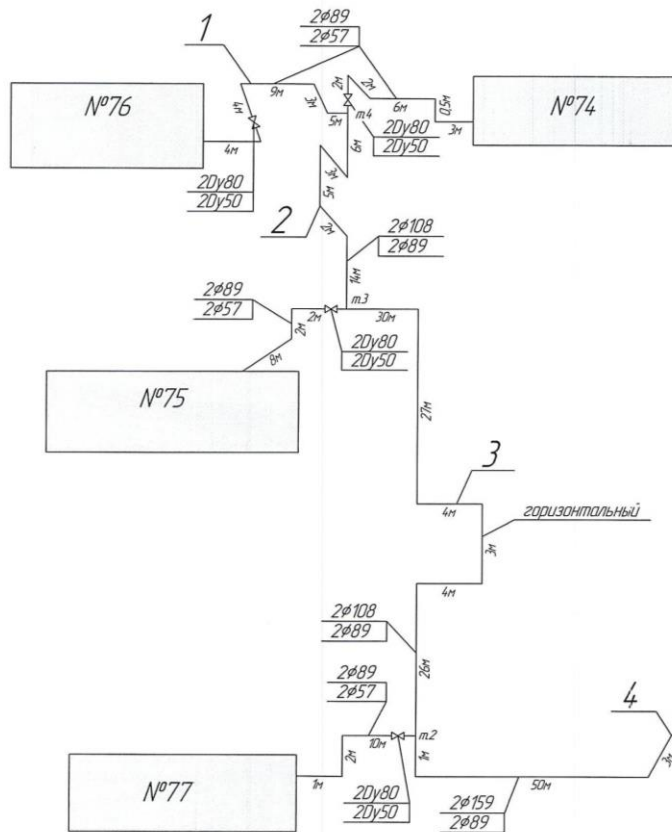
Схема тепловых сетей котельной №4-7 п.г.т. Безенчук
